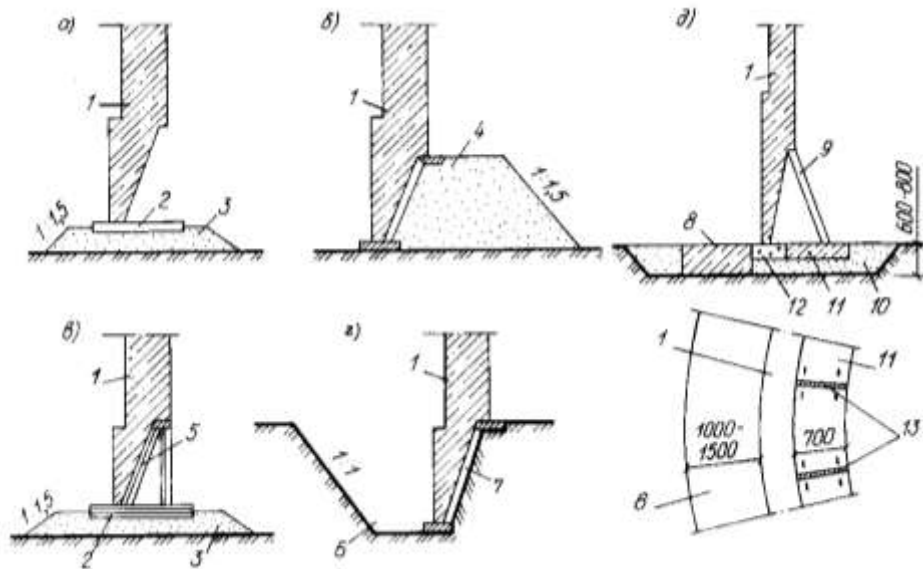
Схема улаштування ножа опускного колодязя на тимчасову основу: а – на піщану основу; б – підкладки із деревини; в – на насипній ґрунтовій чи щебінчатій призмі; г – на піщаній подушці та опорах із деревини; д – на опорному кільці із збірних залізобетонних елементів; 1 – ніж; 2 – підкладка із деревини; 3 – піщана подушка; 4 – ґрунтова призма; 5 – опора із деревини; 6 – траншея; 7 – опалубка із деревини чи залізобетонних плит; 8 – форшахту; 9 – опорна стійка; 10 – піщана засипка; 11 – опорне кільце із збірних залізобетонних блоків; 12 – ущільнена щебінка; 13 – розподільчі дошки
